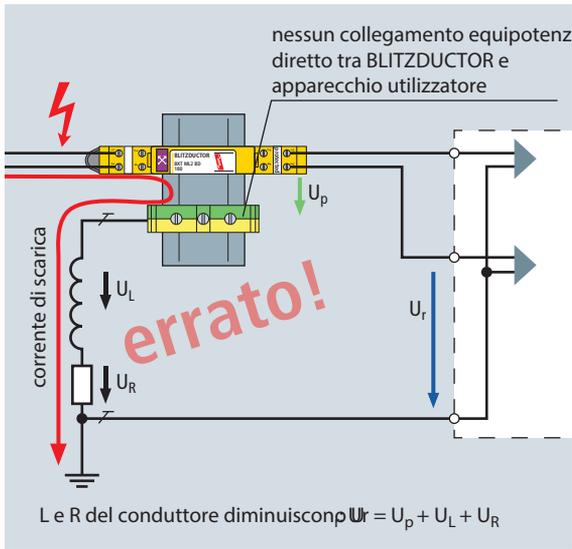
Collegamento equipotenziale non corretto
